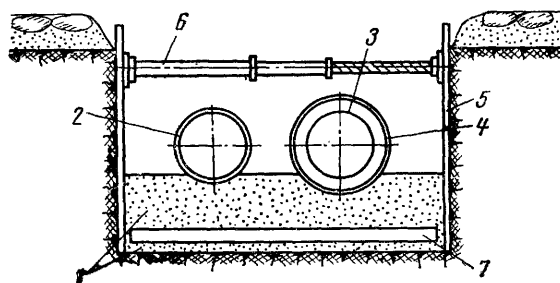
Сечение бесканальной прокладки типов Б-50—Б-1000 в слабых сухих грунтах
